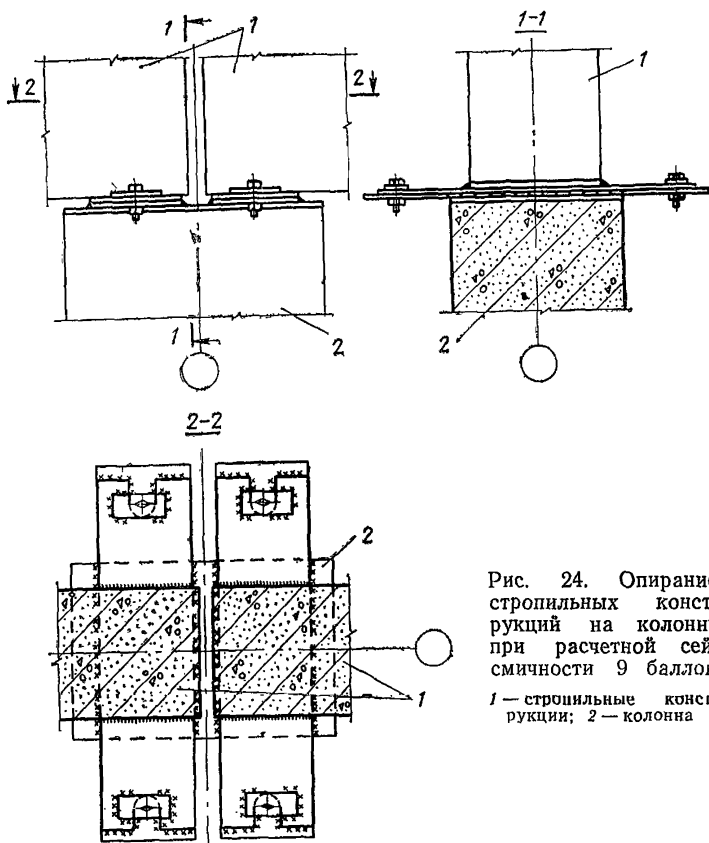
Опираие стропильных конструкций на колонну при расчетной сейсмичности 9 баллов
